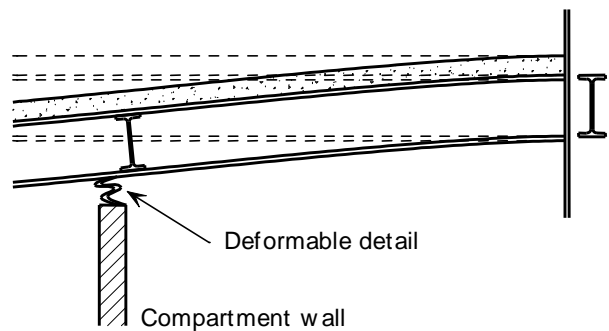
Deformación de las vigas atravesando los muros de compartimentación
